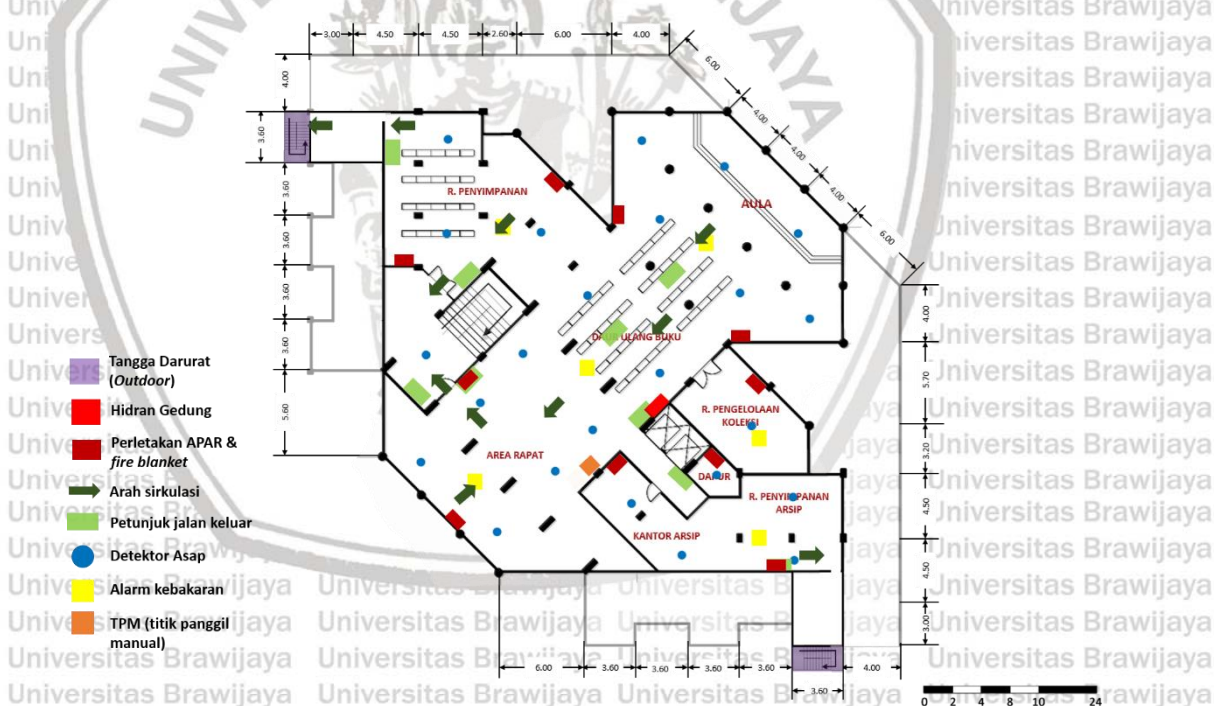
Denah Rekomendasi Overlay Lantai 1
